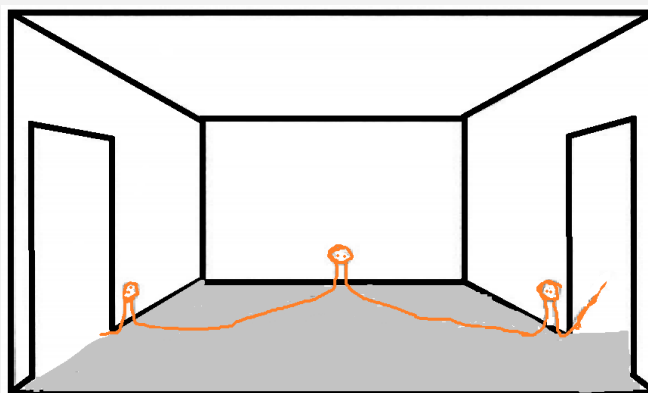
Instalação subterrânea Fonte: [Autor]
